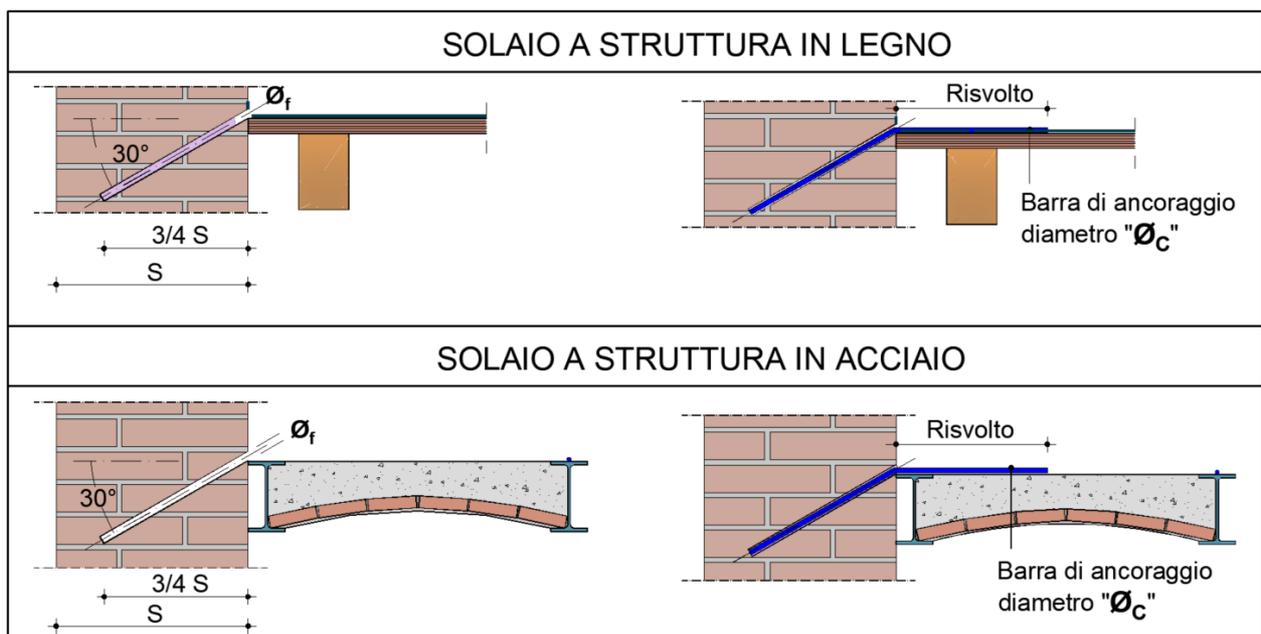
Installazione di barre di armatura per il collegamento tra la soletta HPFRC e le murature.
